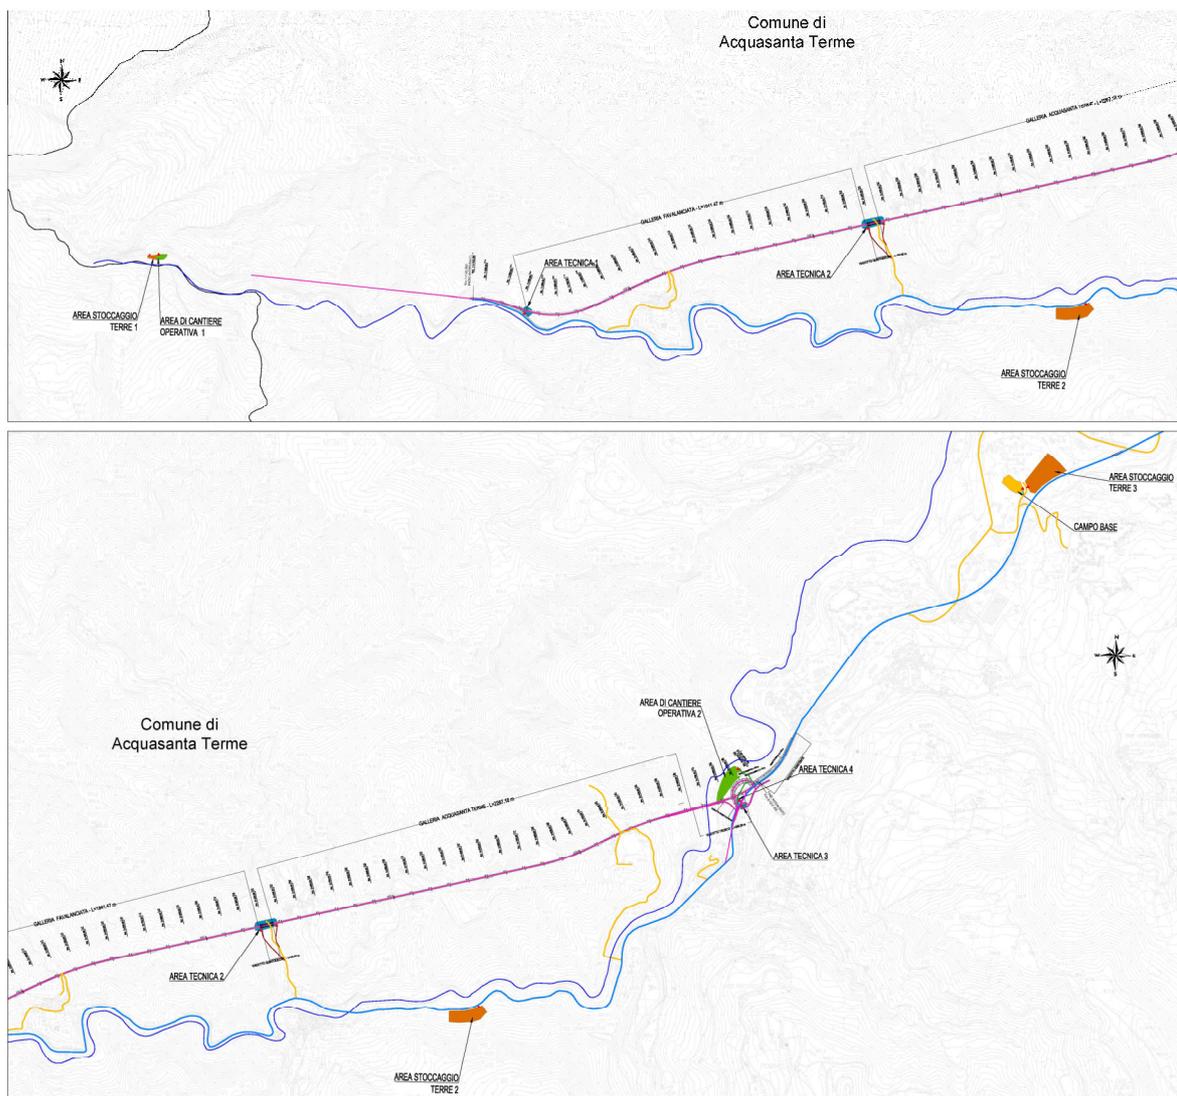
Planimetria con individuazione delle aree di cantiere e viabilità di servizio.
